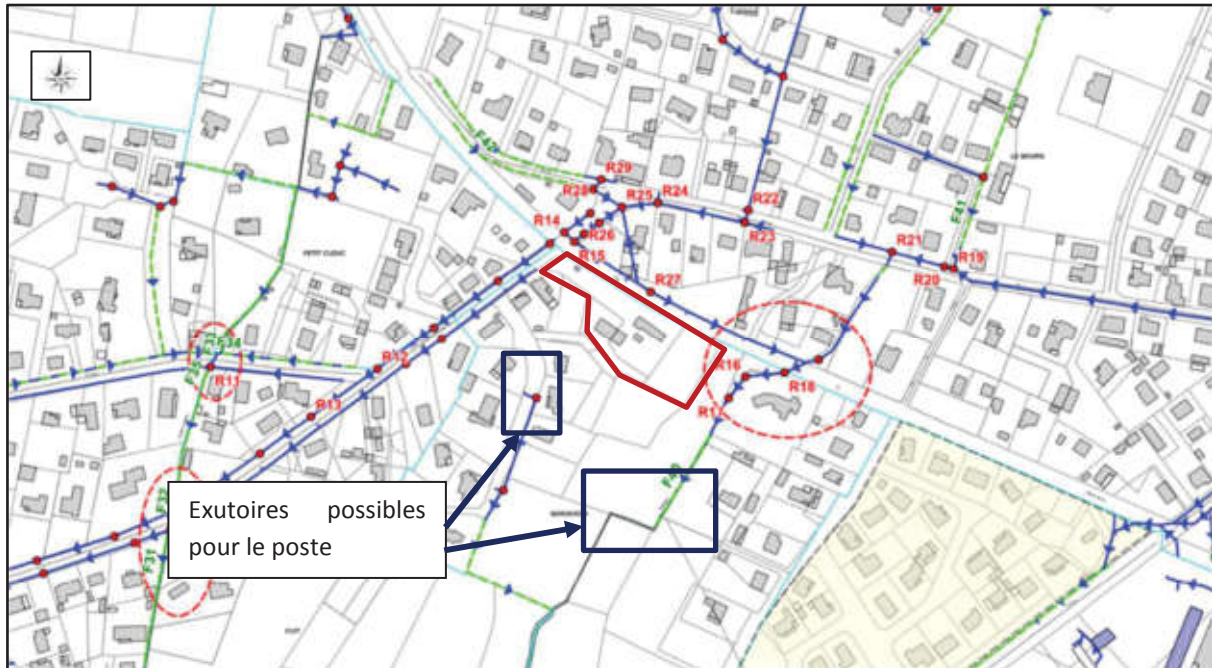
Plan du réseau d'eau pluviale sur la commune de Parentis-en-Born (service technique de la mairie)
